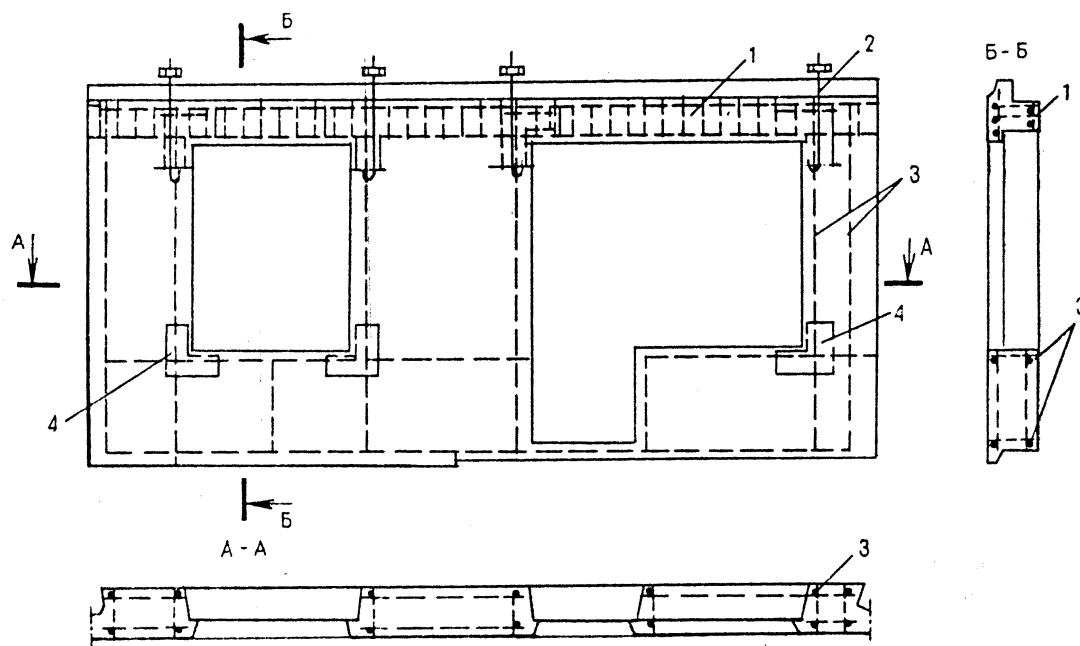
Схема армирования однослойной легкобетонной панели: 1 - арматурный каркас перемычки; 2 - подъемный элемент; 3 - контурный арматурный каркас; 4 - Г-образная арматурная сетка в фасадном слое
